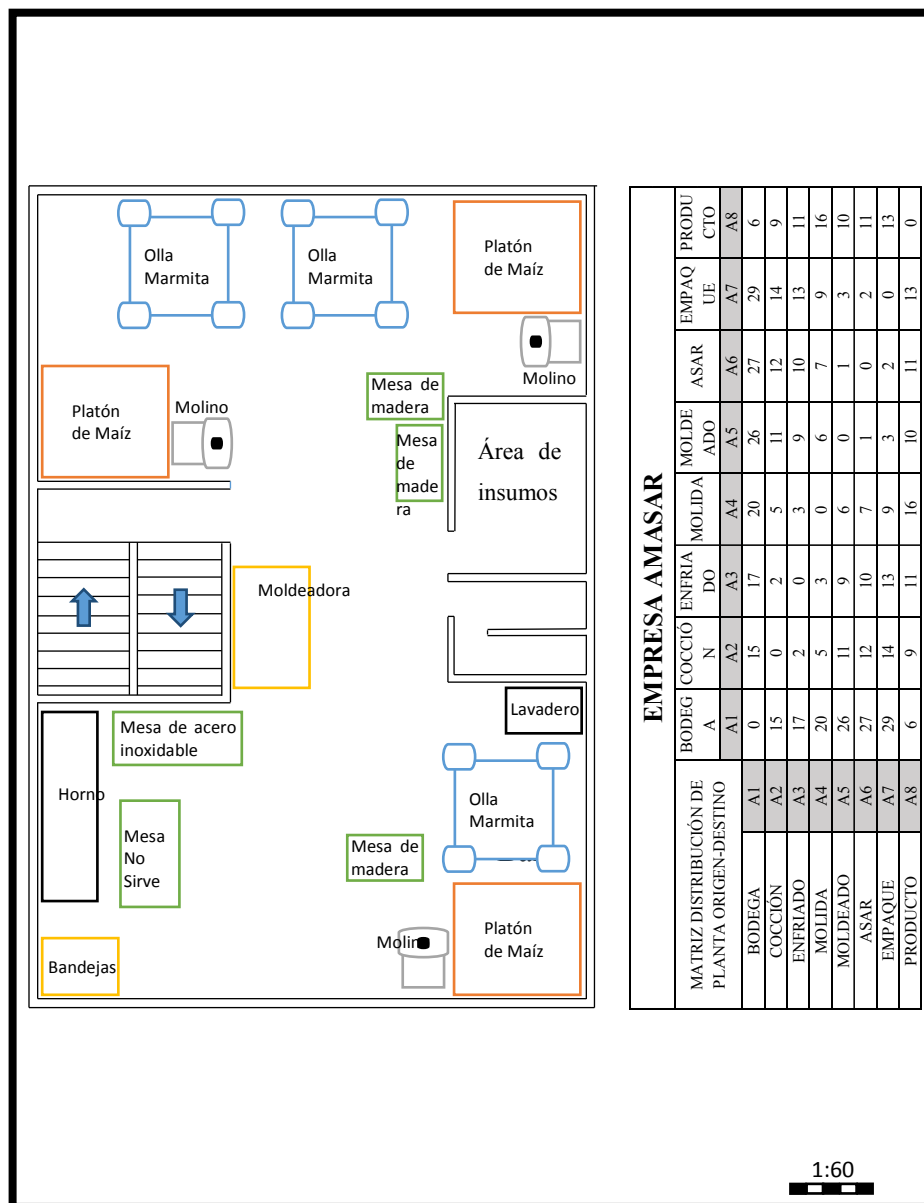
Piso 3. Distribución en planta actual. Nota: Autoría propia.
